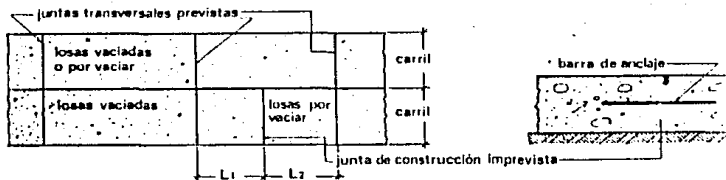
JUNTA TRANSVERSAL DE CONSTRUCCION IMPREVISTA
